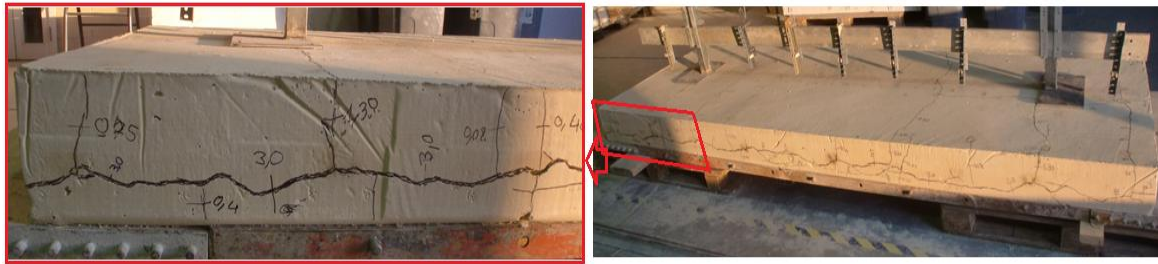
Levantamento das fissuras ocorridas no processo de cura da laje L2.
